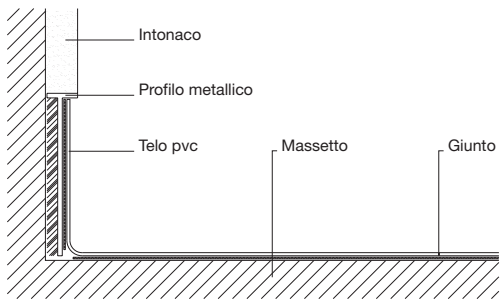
Particolare del raccordo parete-pavimento realizzato con un telo continuo in PVC fatto risvoltare senza soluzione di continuità. Lo zoccolino risulta leggermente incassato rispetto al filo della parete.
